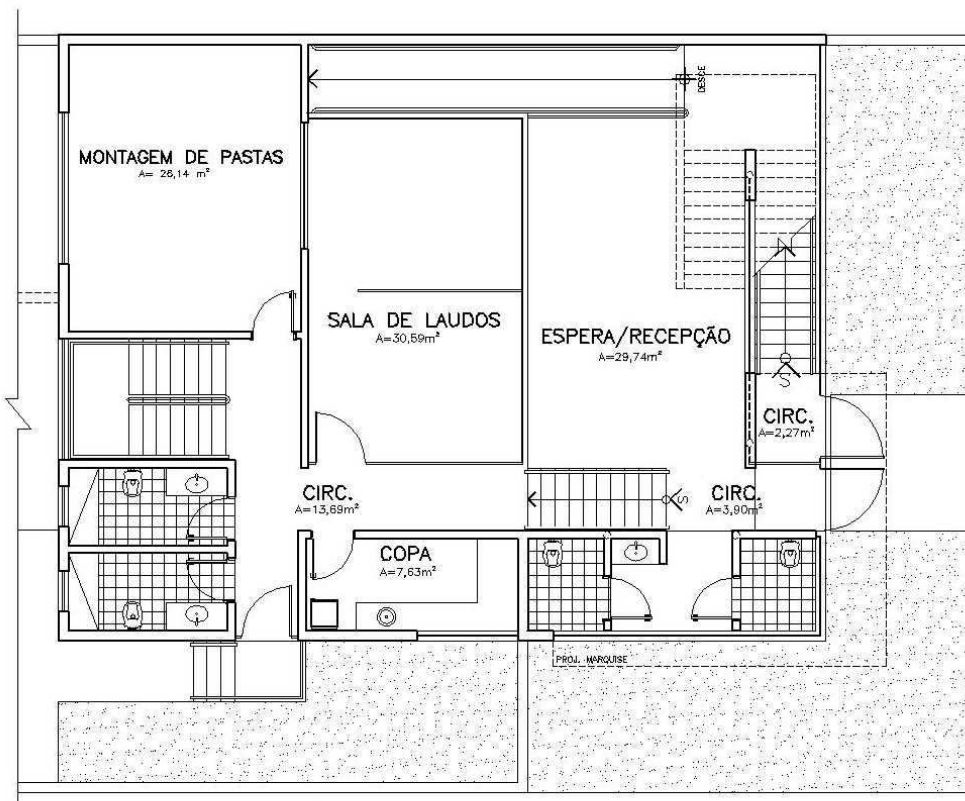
Planta baixa do pavimento térreo – Obra C
